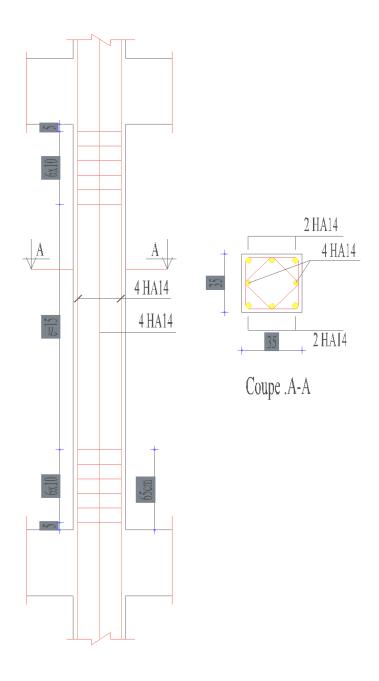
Schéma de ferraillage des poteaux (35 x 35)
